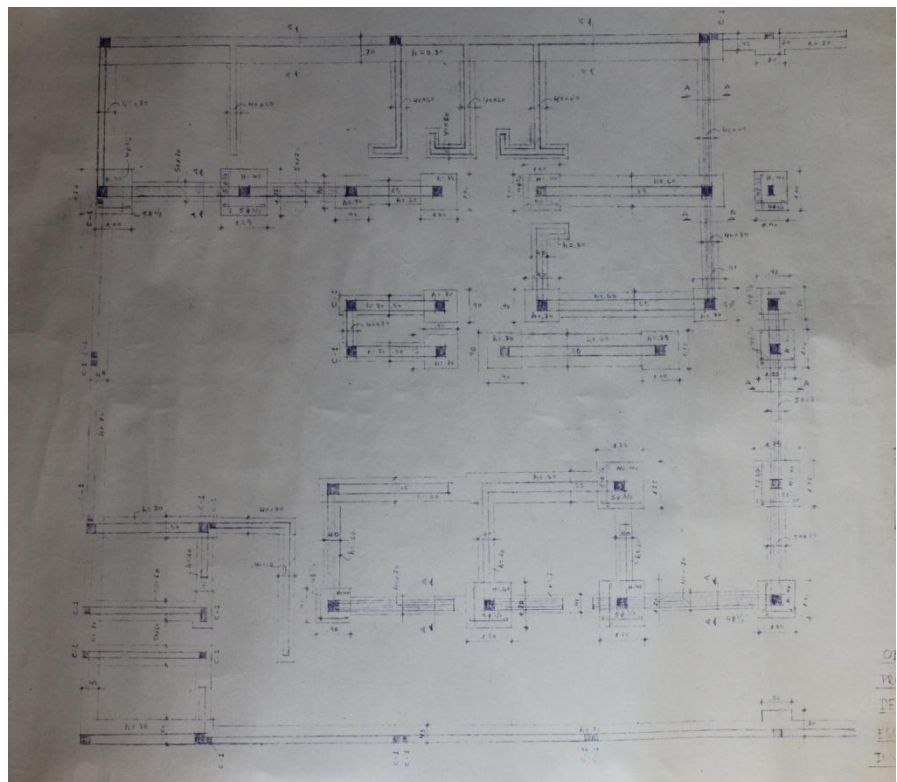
Plano de cimentación. Fuente: Propia.
